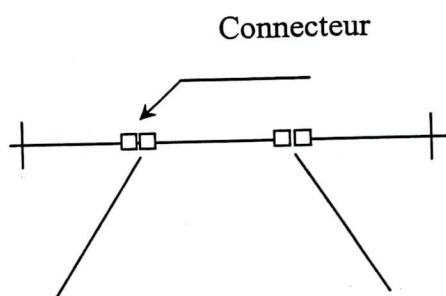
modélisation de la poutre contreventée par des diagonales excentriques
